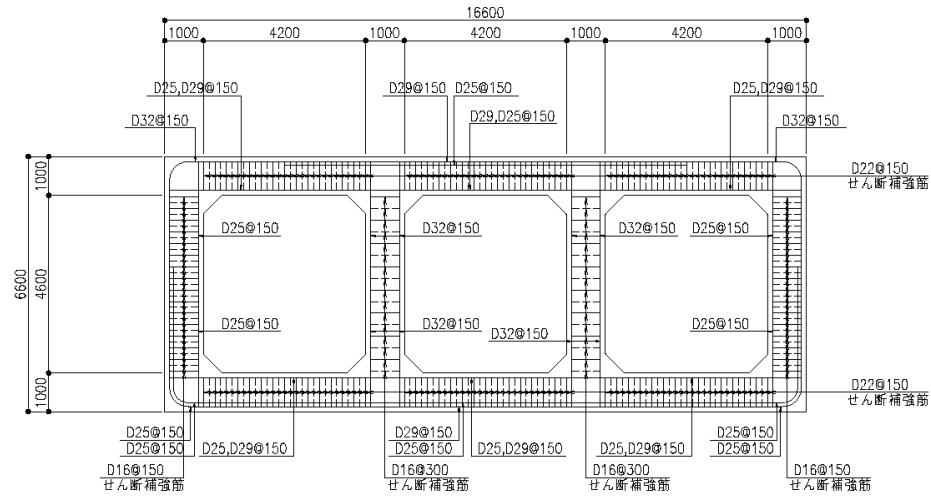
取水路 (6号機設備) の配筋図 (一般部, B-B断面)
